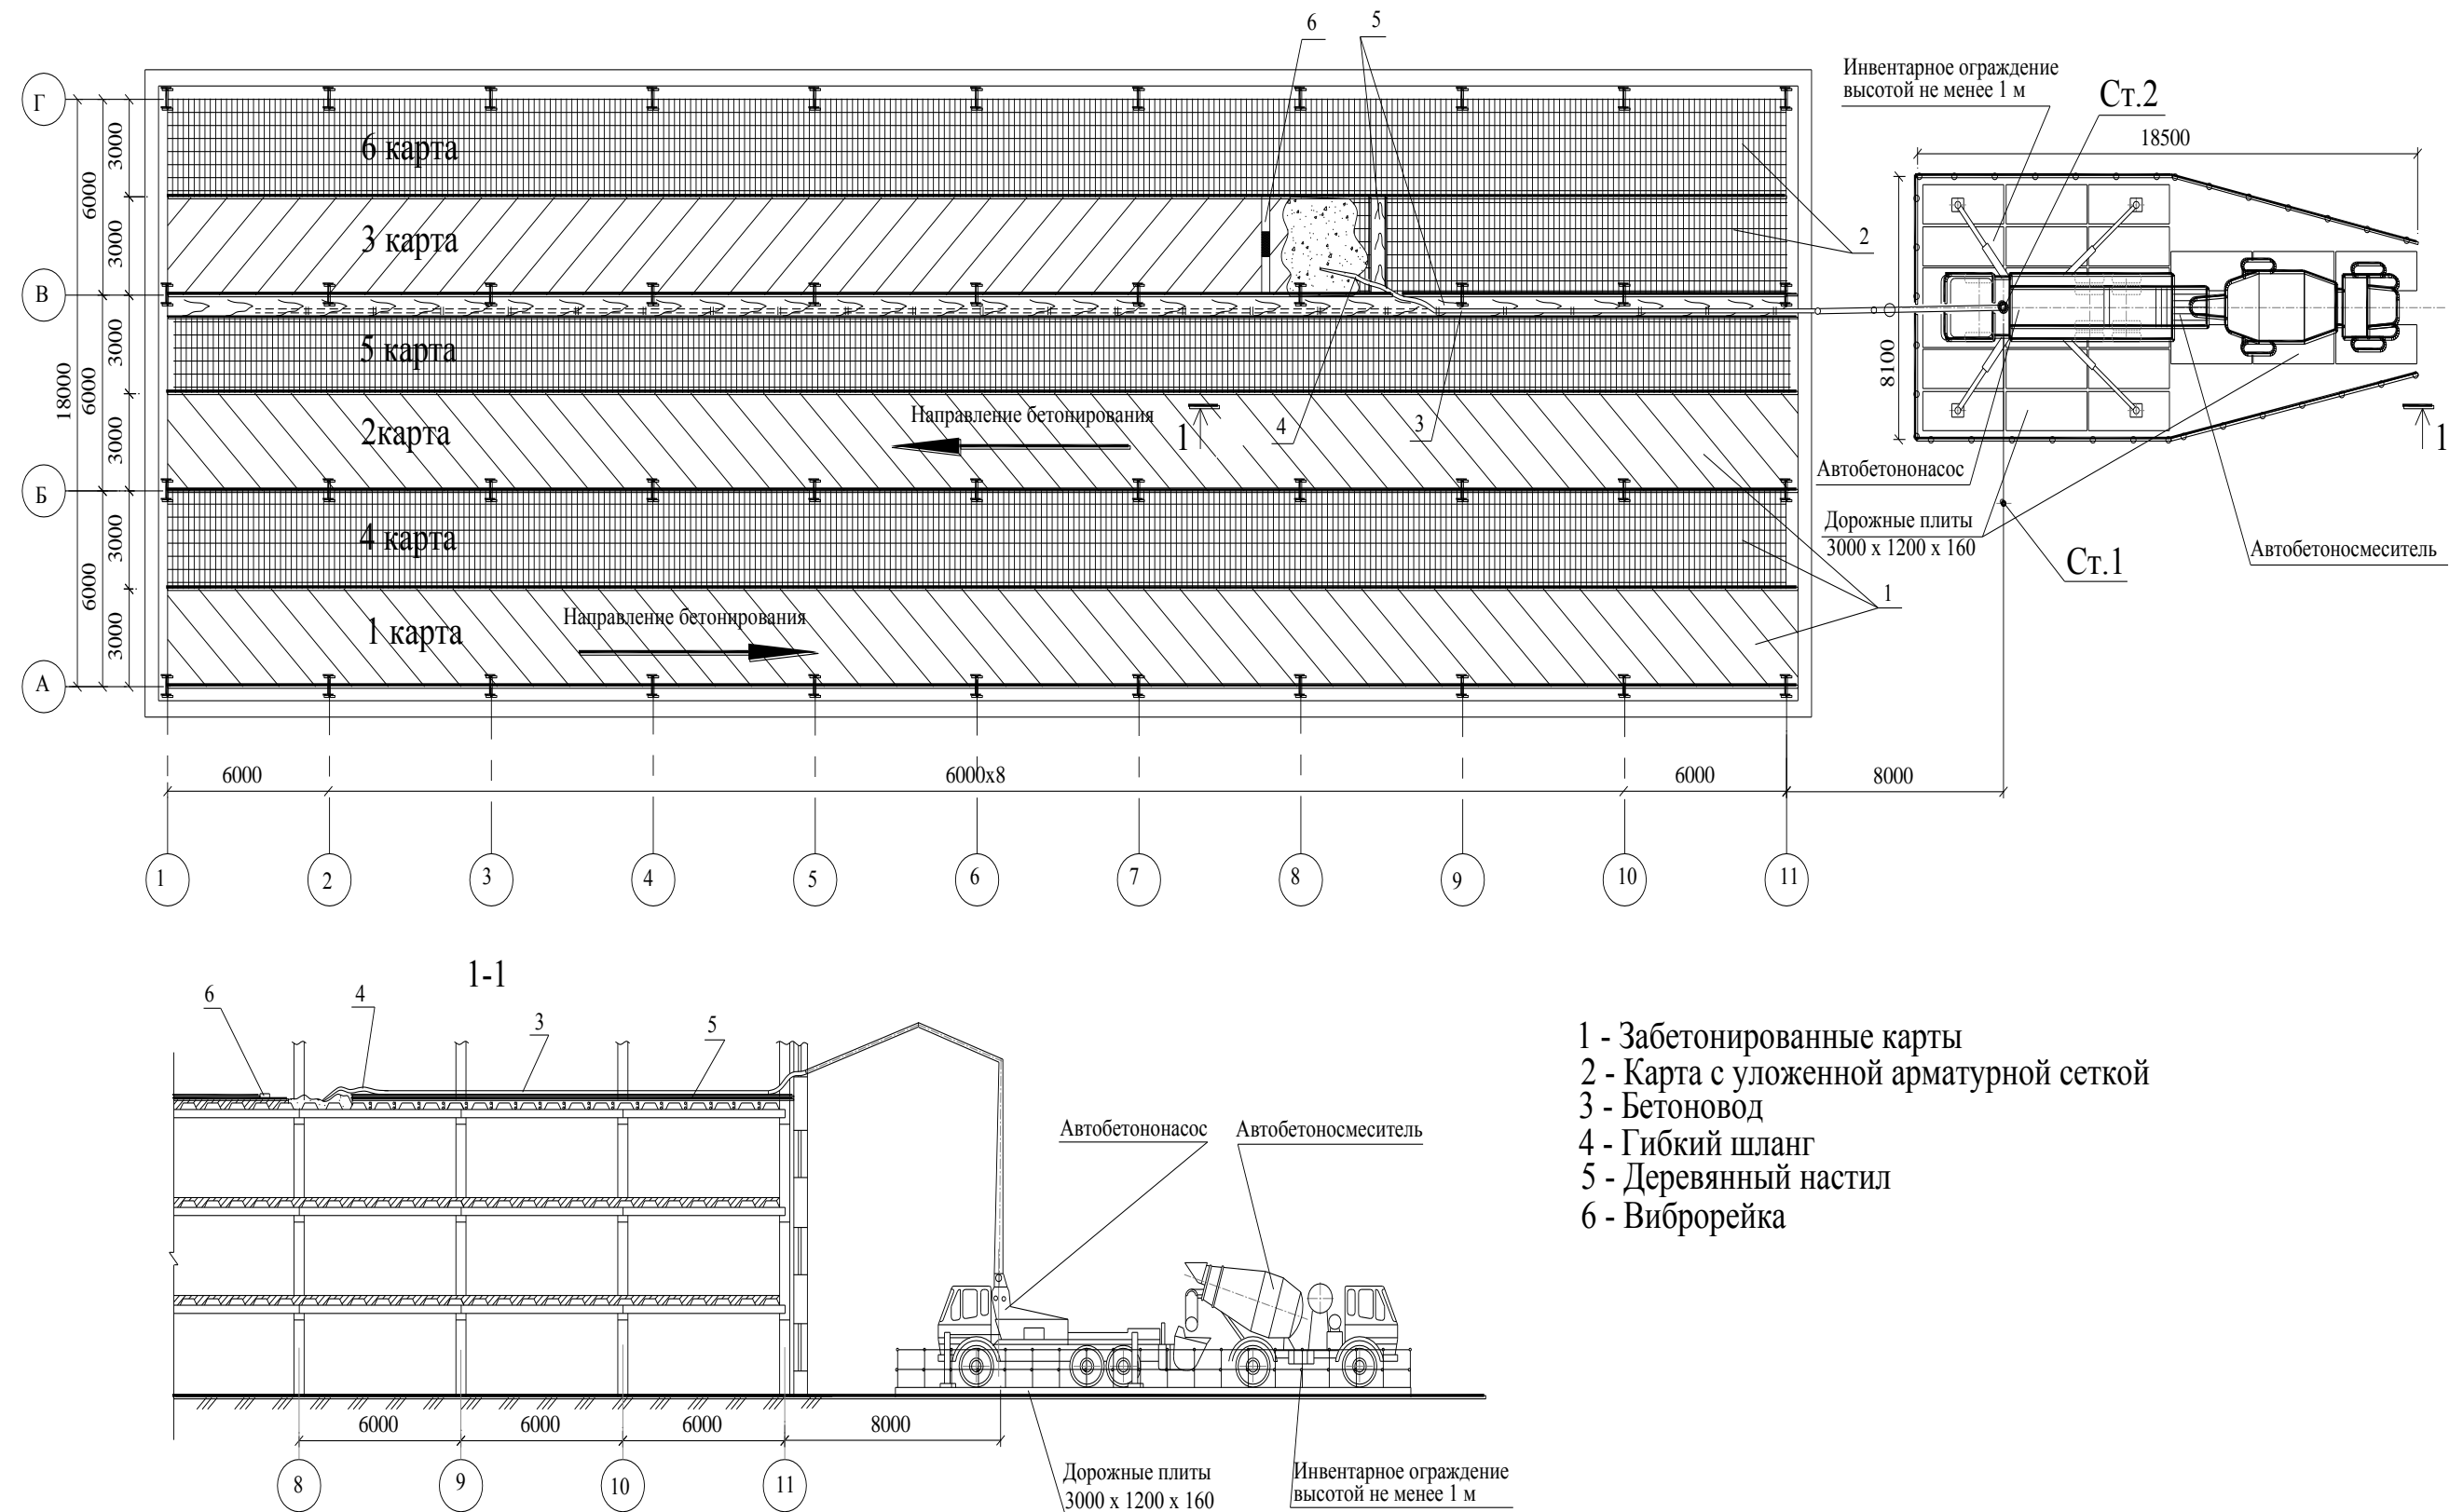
Производство работ по бетонированию перекрытия автобетононасосом на примере общественного здания
